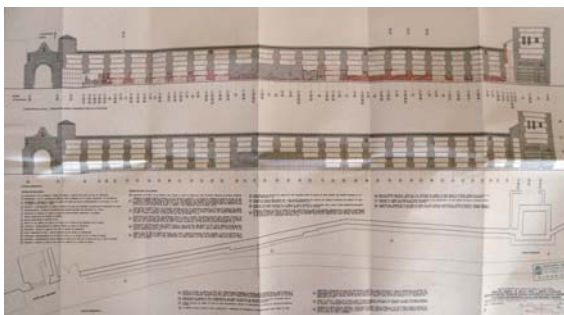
Imagen del proyecto en la que se define el ámbito de actuación y las patologías previas a la intervención en la muralla. Expediente PI 0829.02 del archivo del IPCE.
